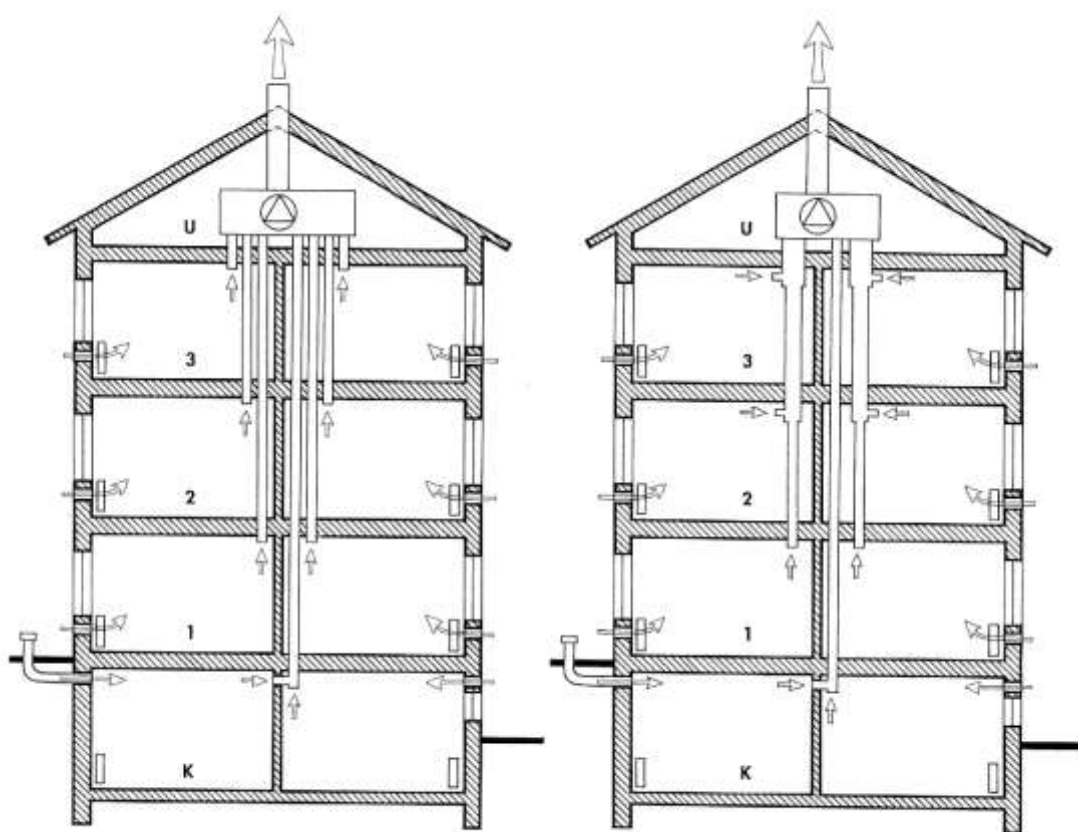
Här ser vi hur maskineriet till utsuget är installerat på vinden och sköter utsuget, medan det passivt kommer in frisk luft till rummen genom ventiler i väggen. Vänstra bilden har mera dragna rör för de kommer skilda till varje lägenhet. På högra sidan är rören ihopkopplade till ett gemensamt rör.
